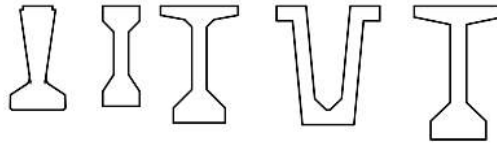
Tipos de seções de vigas pré-moldadas de concreto protendido comumente utilizadas. Fonte: PINHO (2011).
